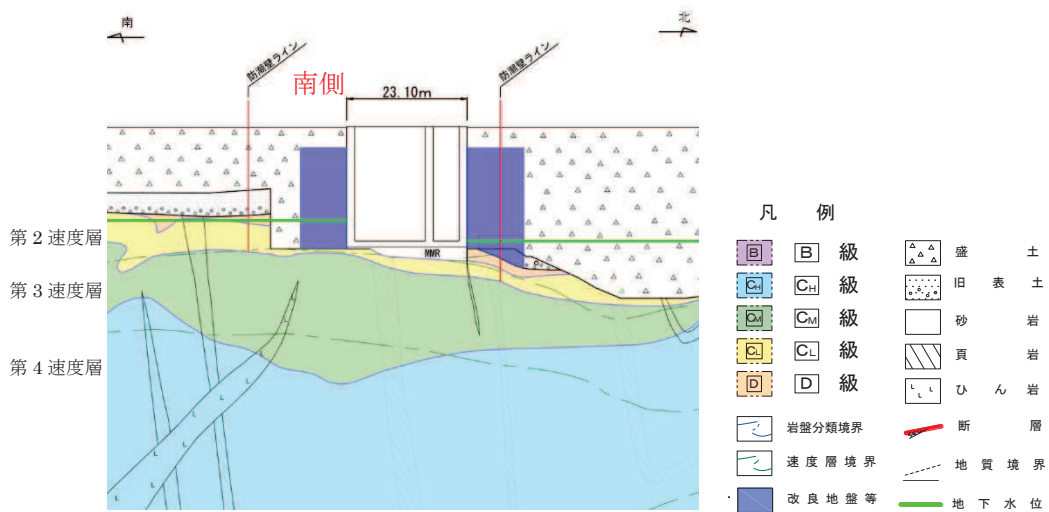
第3号機放水立坑地質断面図 (B-B断面)
